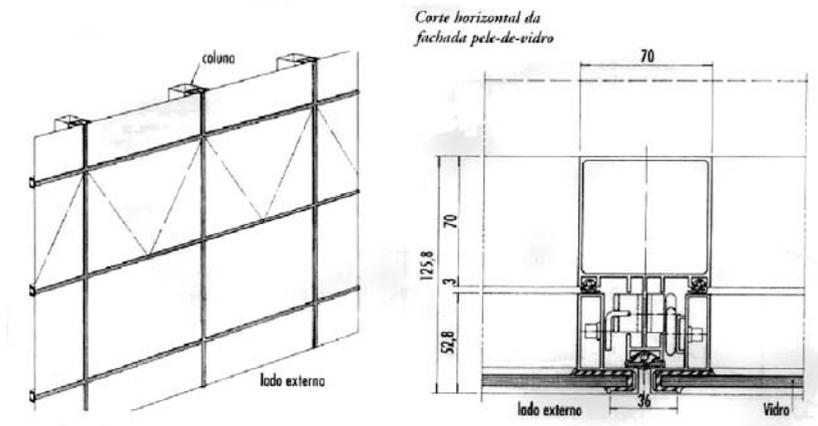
Fachada pele de vidro. Fonte :Corcuera(1999)
